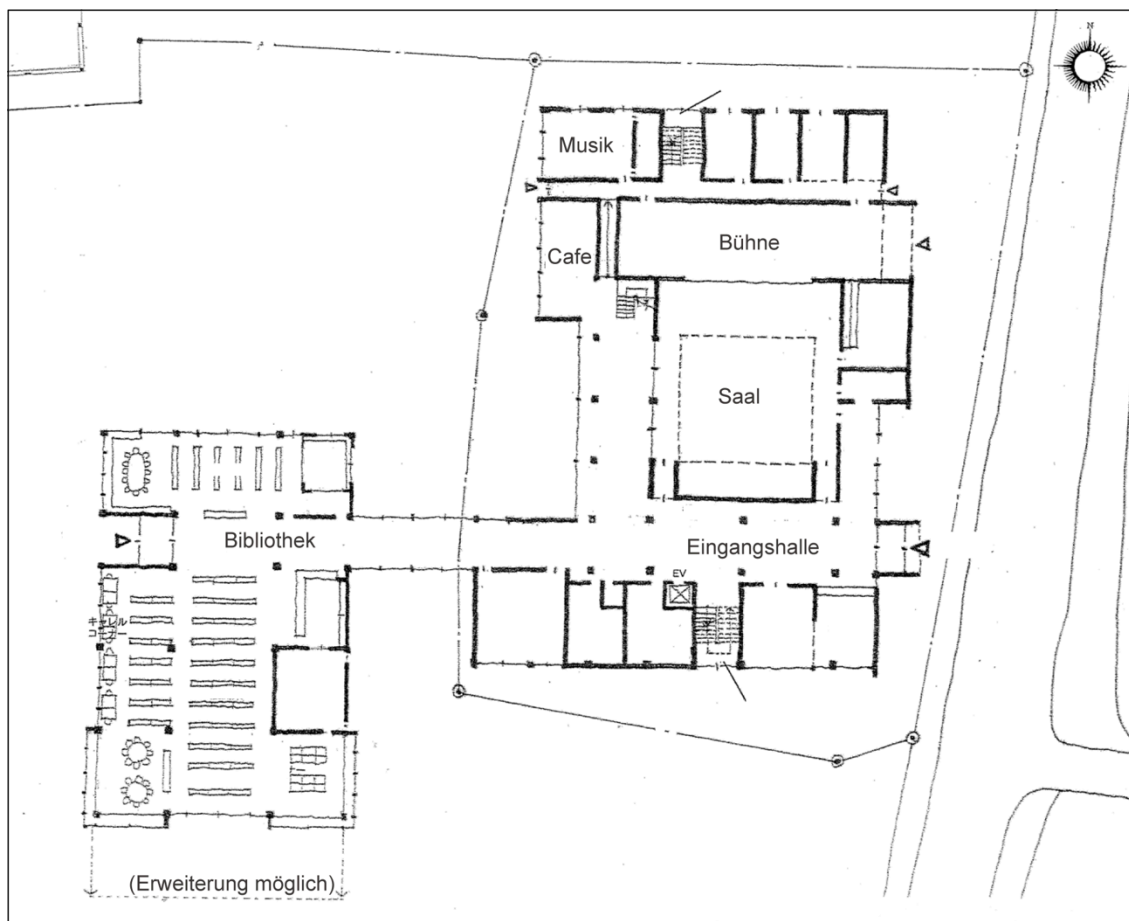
Vorschlag 1: Grundriss (ebd. No.7, 3) (Übersetzung v. Verf.)
